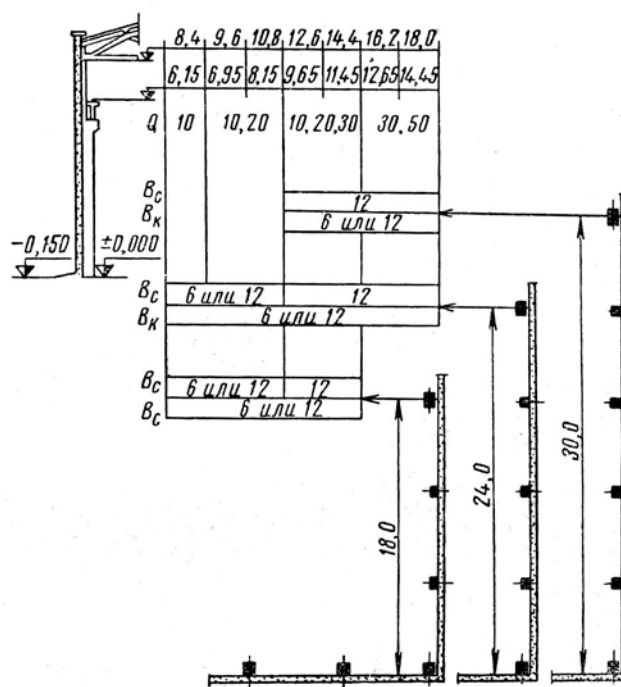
Унифицированная габаритная схема для одноэтажных промышленных зданий с мостовыми кранами: V_c – шаги колонны по средним рядам; V_k – по крайним рядам; Q – грузоподъемность, т
